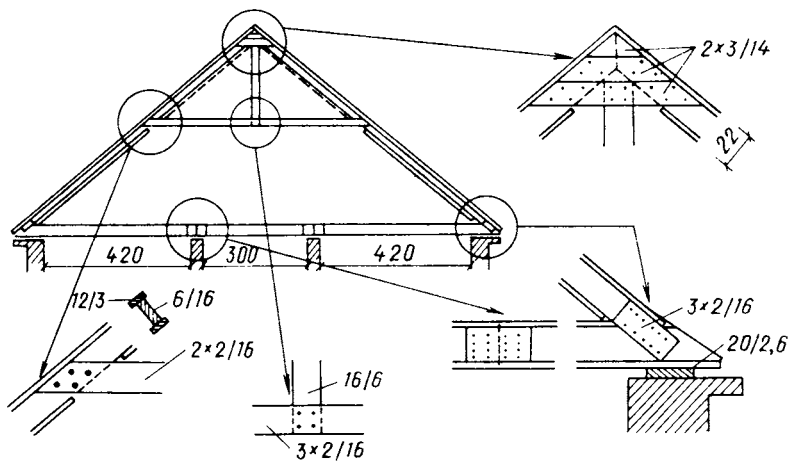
Современная треугольная стропильная конструкция с повышенной затяжкой (поперечный разрез с деталями)
